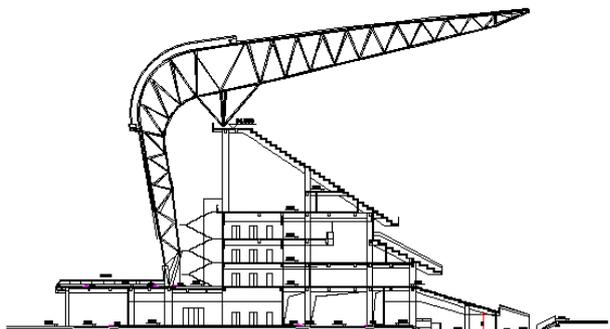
混凝土框架-剪力墙看台+悬挑罩棚体育场剖面图
